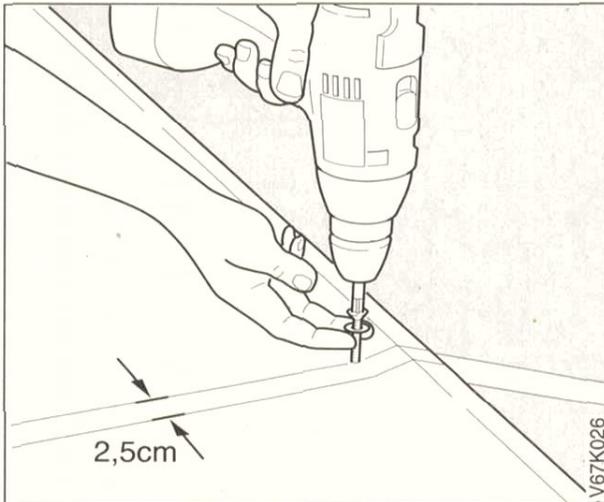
Zwischen die Überlappung der oberen Eindeckbleche Silikon auftragen und mit 3 Sprengerschrauben verbinden. Zu den Blechrändern ca. 2,5 cm Abstand einhalten.
